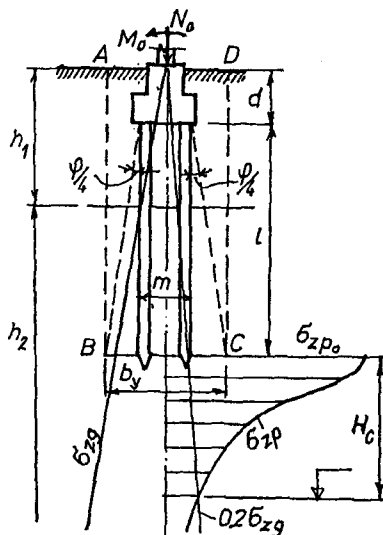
К примеру расчета осадки условного свайного фундамента
